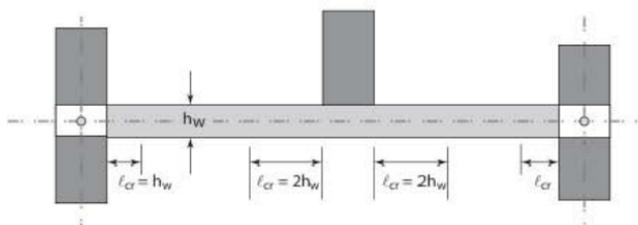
Zones critiques d'une poutre primaire supportant un poteau interrompu
